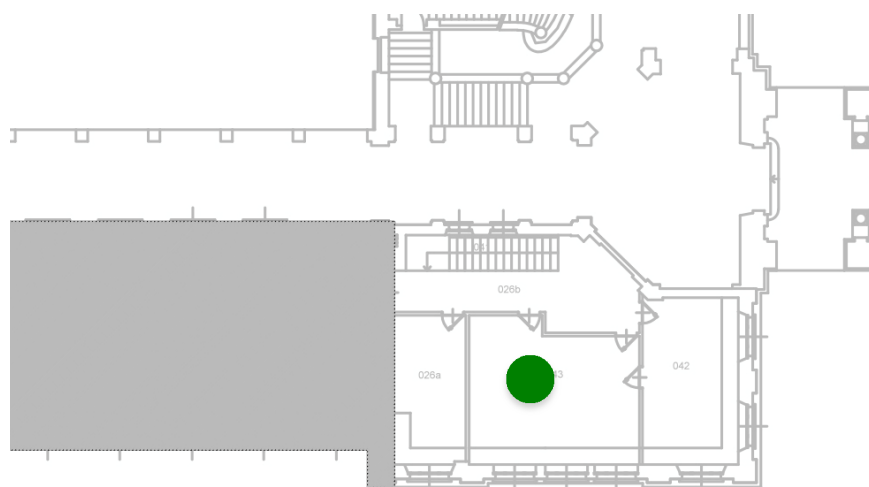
Ingrandimento zona interessata Pianta Piano Soppalco
